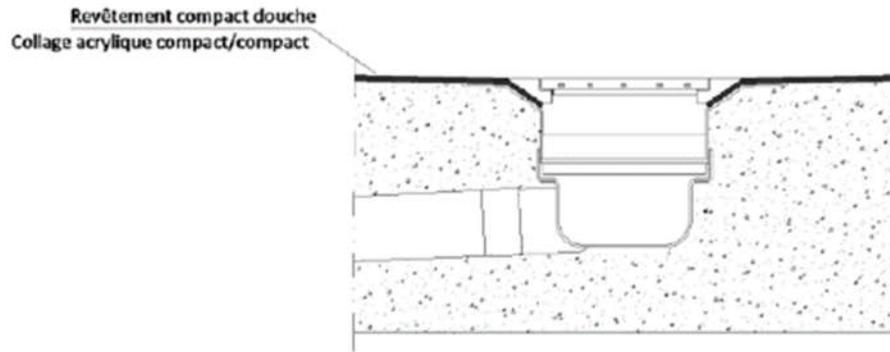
Implantation d'un siphon dans une dalle béton (enduit de sol non représenté)
